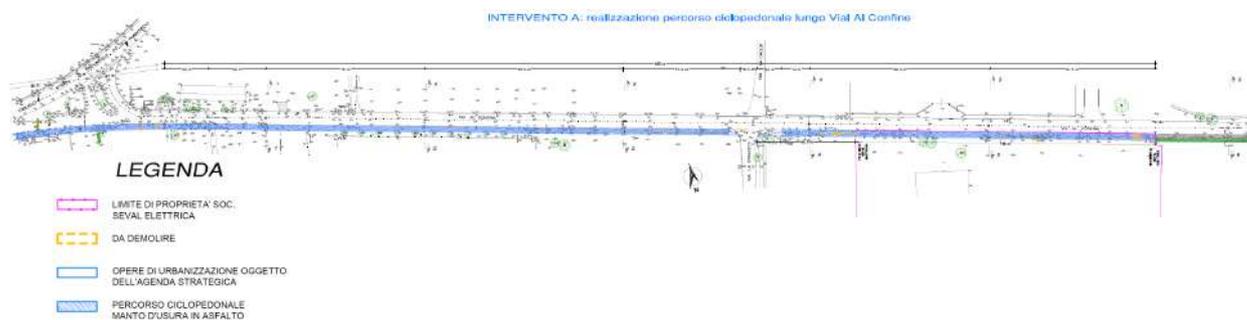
Estratto planimetria generale progetto definitivo pista ciclabile – Tracciato di progetto
